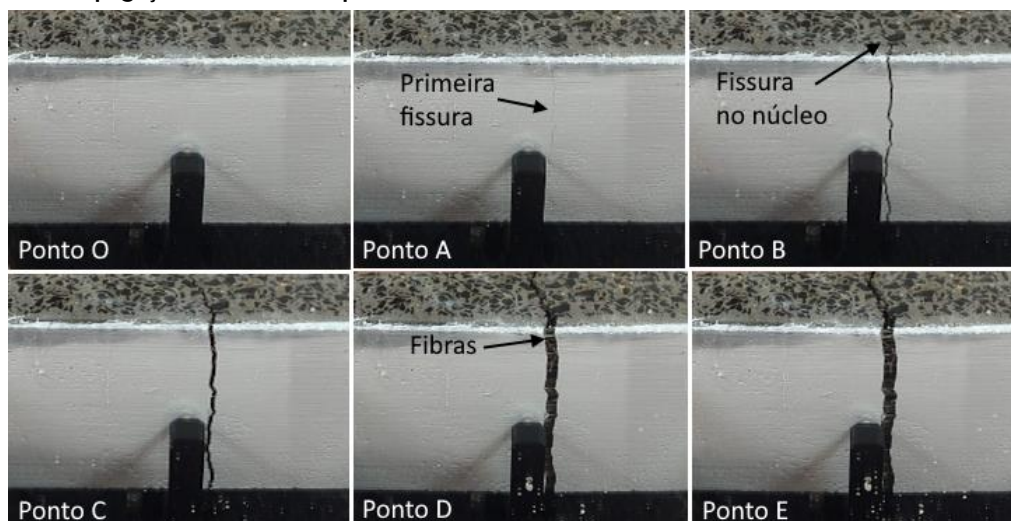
Propagação da fissura no painel sanduíche sob flexão
